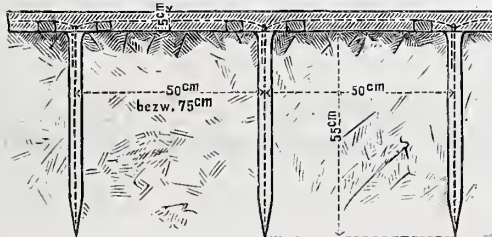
Längenschnitt durch die Betondecke. 1:20.
